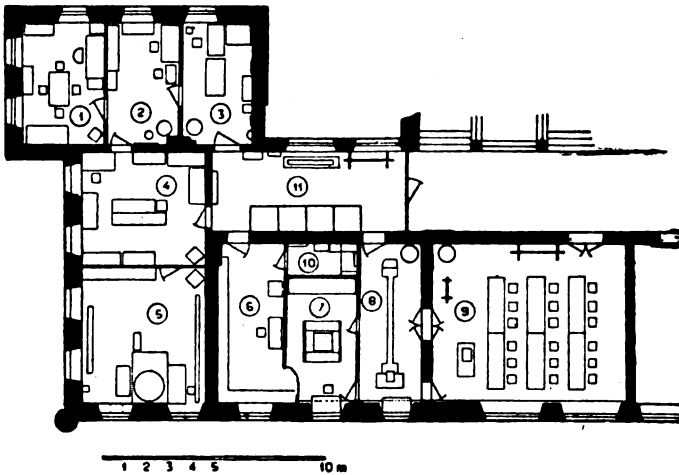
Grundriß des Instituts im 1. Obergeschoß.
